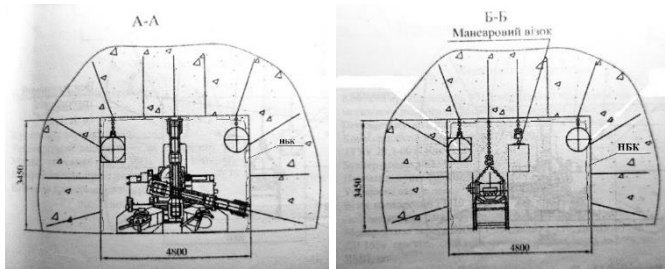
Перетини виробки прямокутної форми з анкерно-набризкбетонним кріпленням
